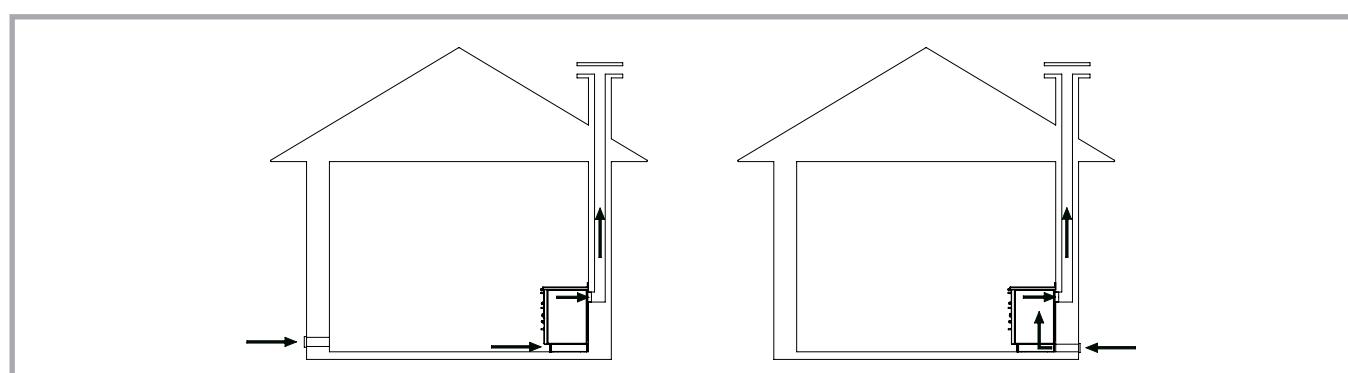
Installazione mediante presa d'aria nel locale e installazione con presa d'aria esterna collegata direttamente alla cucina a legna.
